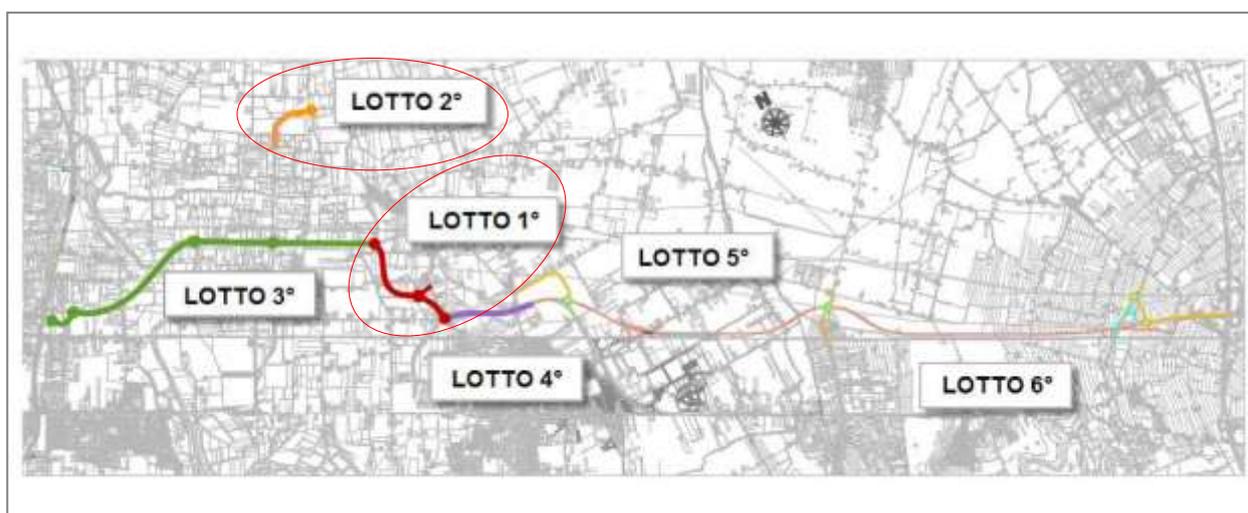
planimetria con l'ubicazione dei lotti della infrastruttura.
